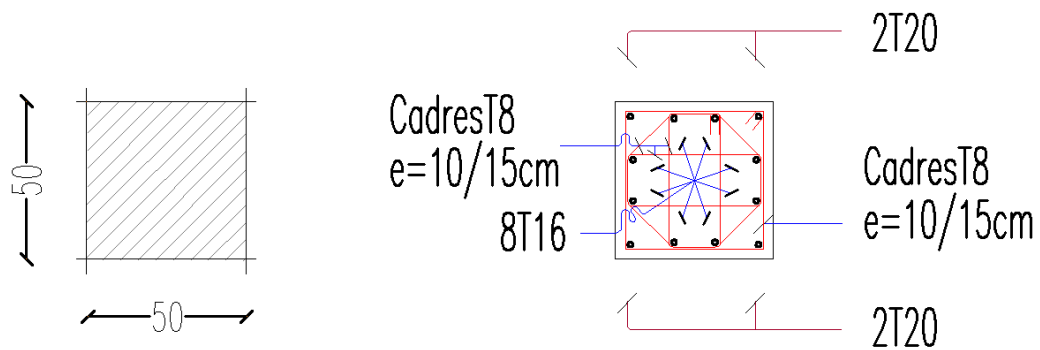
Schéma de ferrailage des poteaux 50x50
